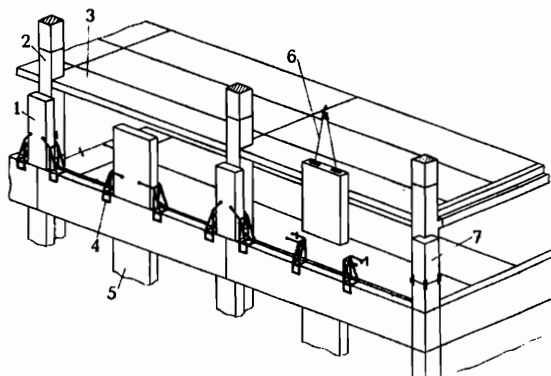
Установка простеночных и угловых панелей стен при помощи струбцин с откидными хомутами: 1 – простеночная панель у колонны; 2 – колонна; 3 – связевая плита; 4 – струбцина с откидным хомутом; 5 – простеночная панель; 6 – двухветвевой строп; 7 – угловая панель, временно закрепленная при помощи троса с натяжным устройством
